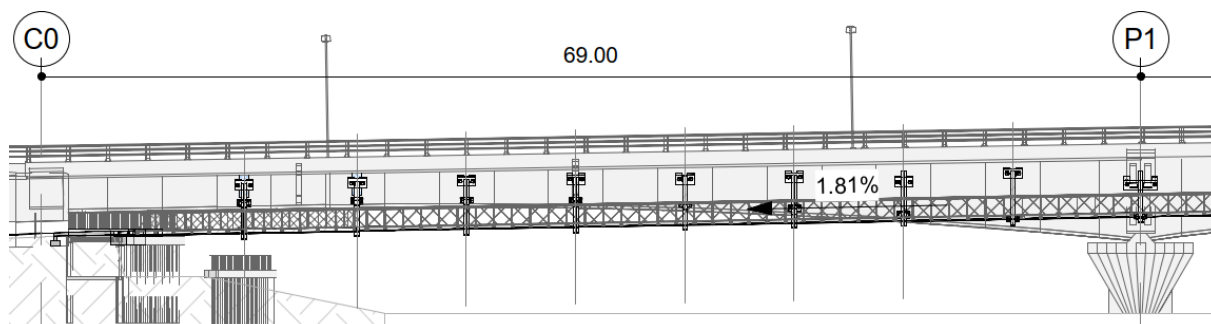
Consoles accrochées latéralement au pont sur la travée de rive T1 - Extrait du cahier de plans PRO
